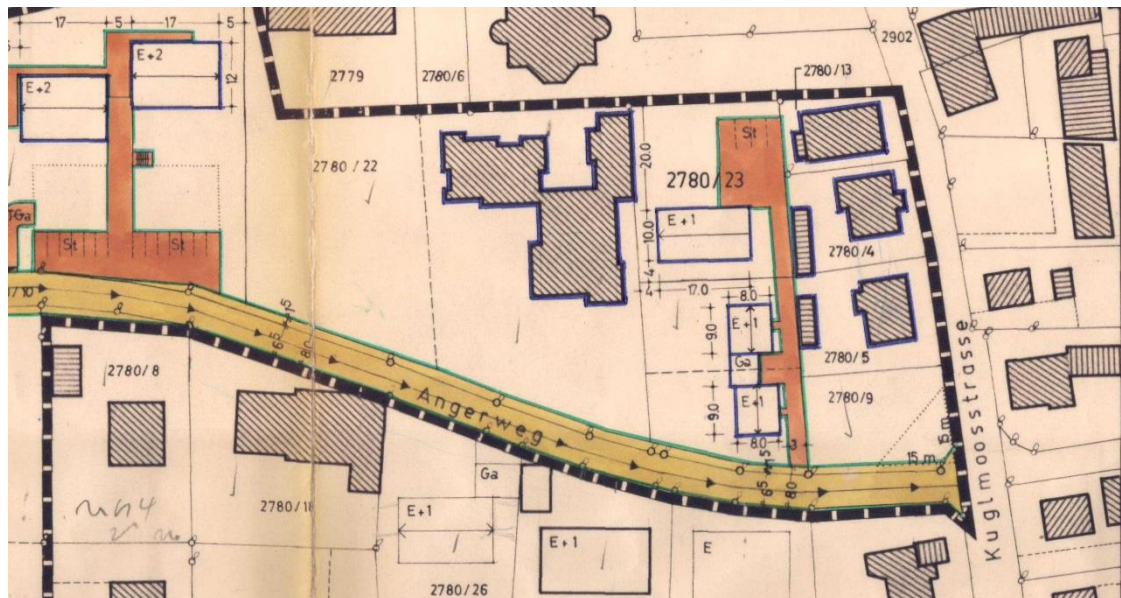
Ur-Bebauungsplan im Bereich der Änderung - ohne Maßstab!
